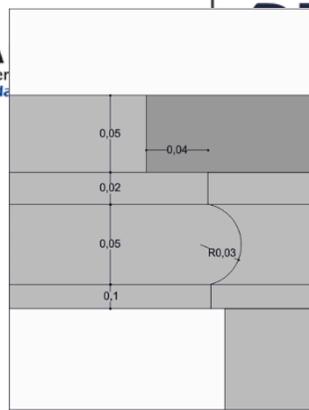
Detalle 2, detalle frontón, Estación del ferrocarril Sur.
